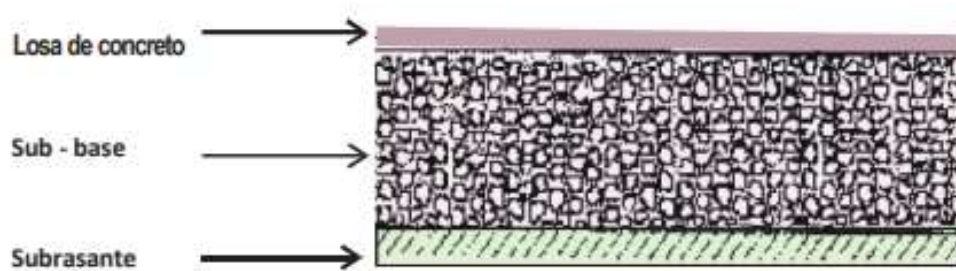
Sección de pavimento rígido. (Fuente: Manual para la revisión de diseño de pavimentos)
